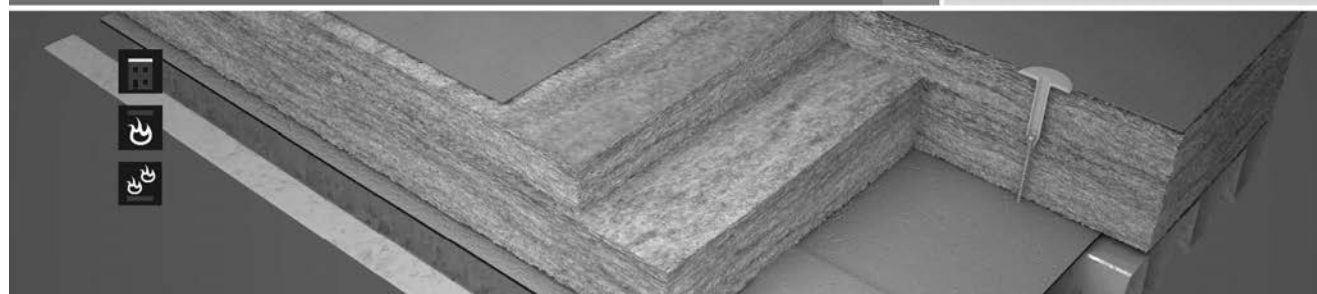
Detail u vtoku (skladba DEKROOF 12-B)
